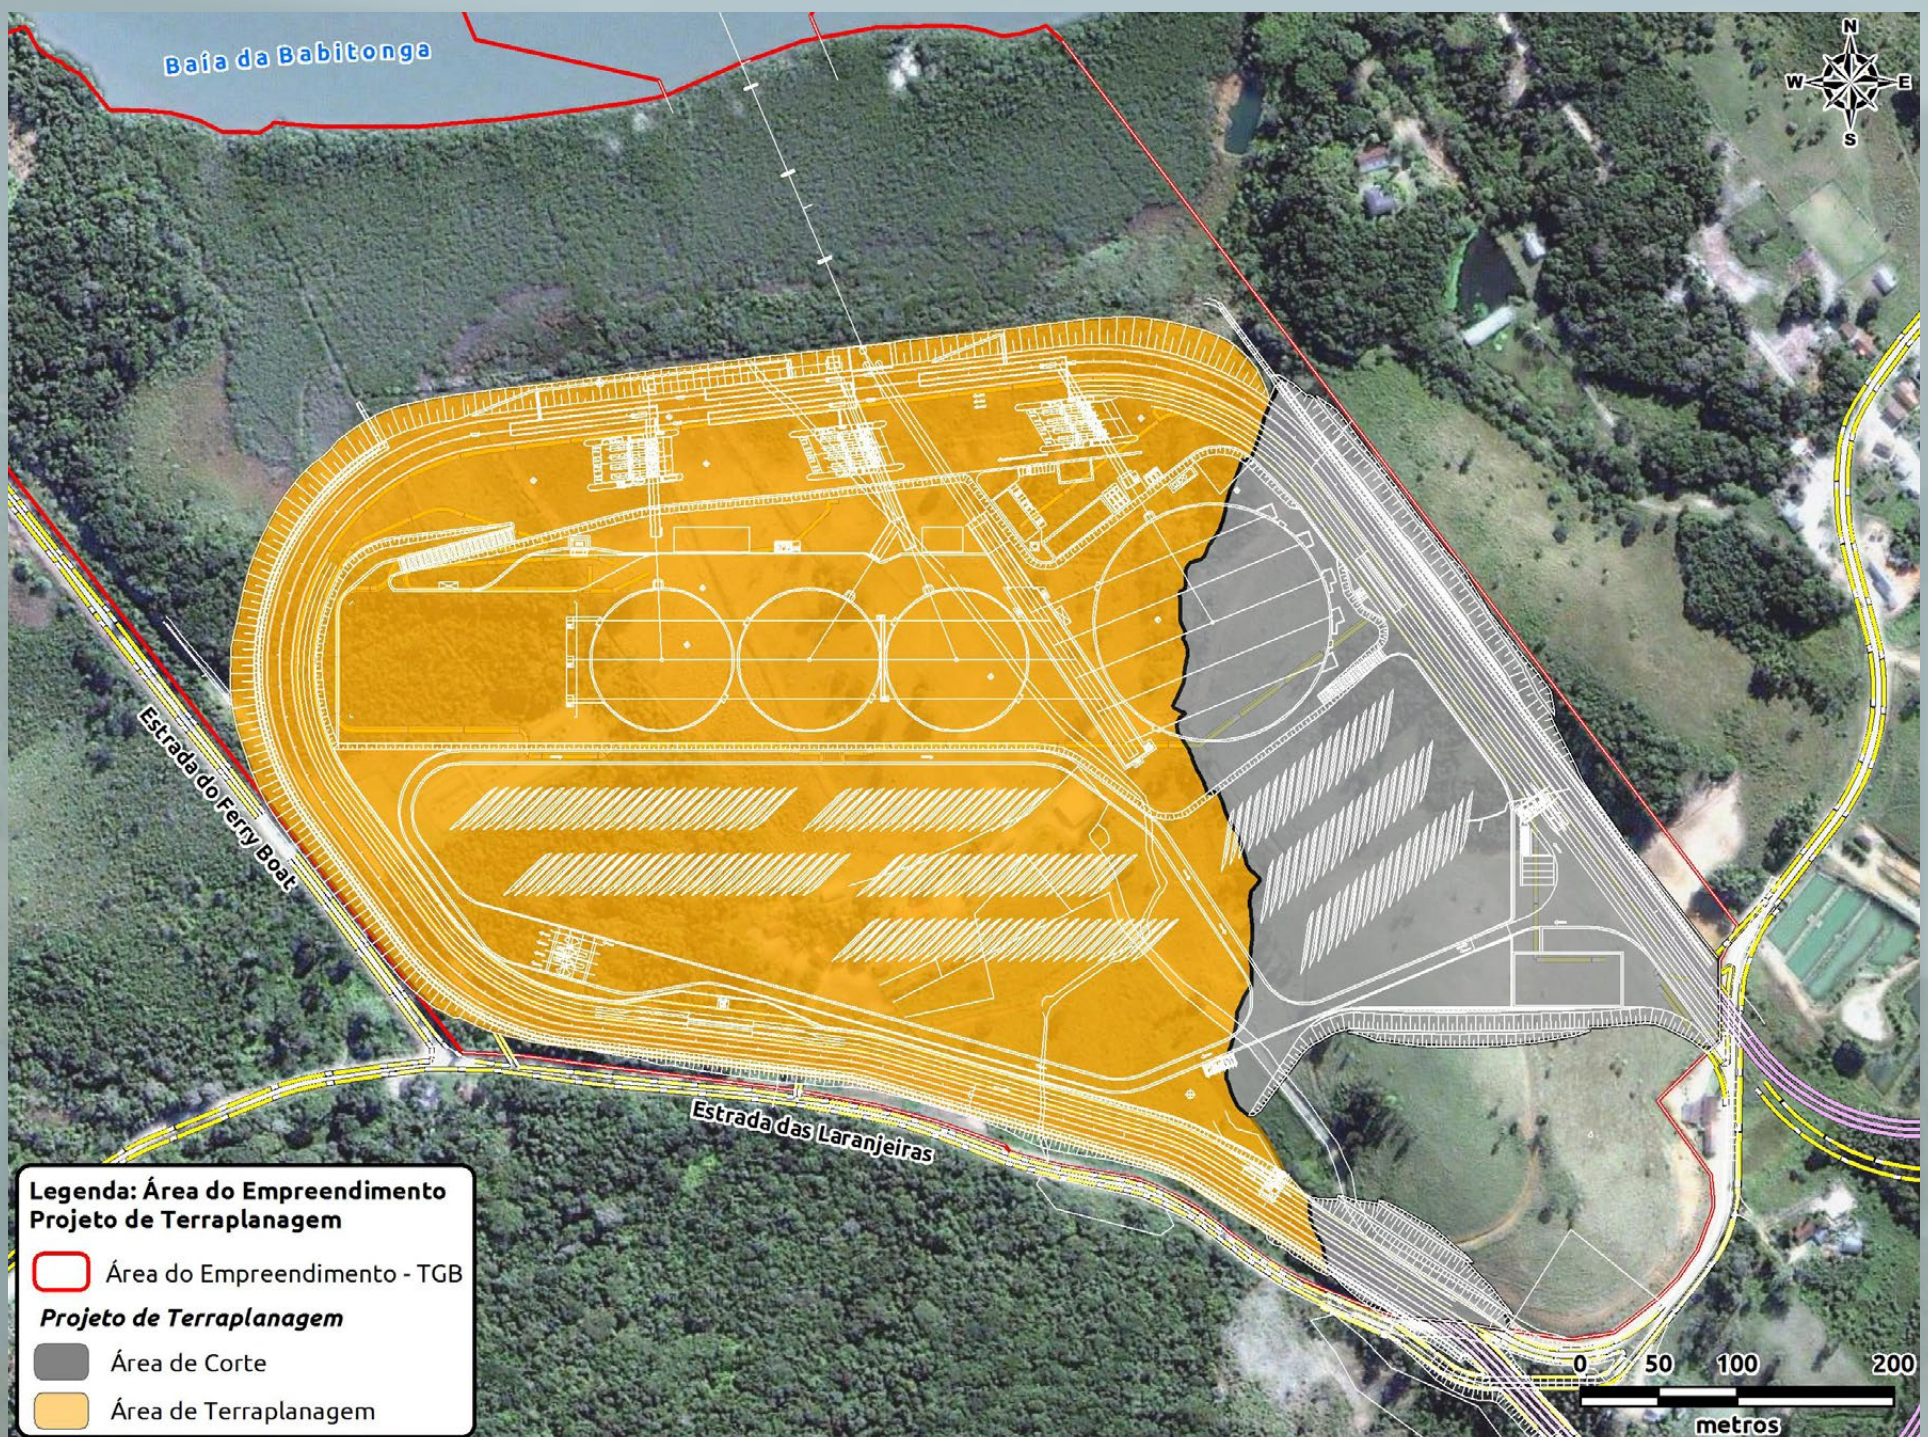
Planta de terraplanagem do Terminal Graneleiro da Babitonga – TGB, sendo em cinza a área de corte e em laranja a área de aterro.
